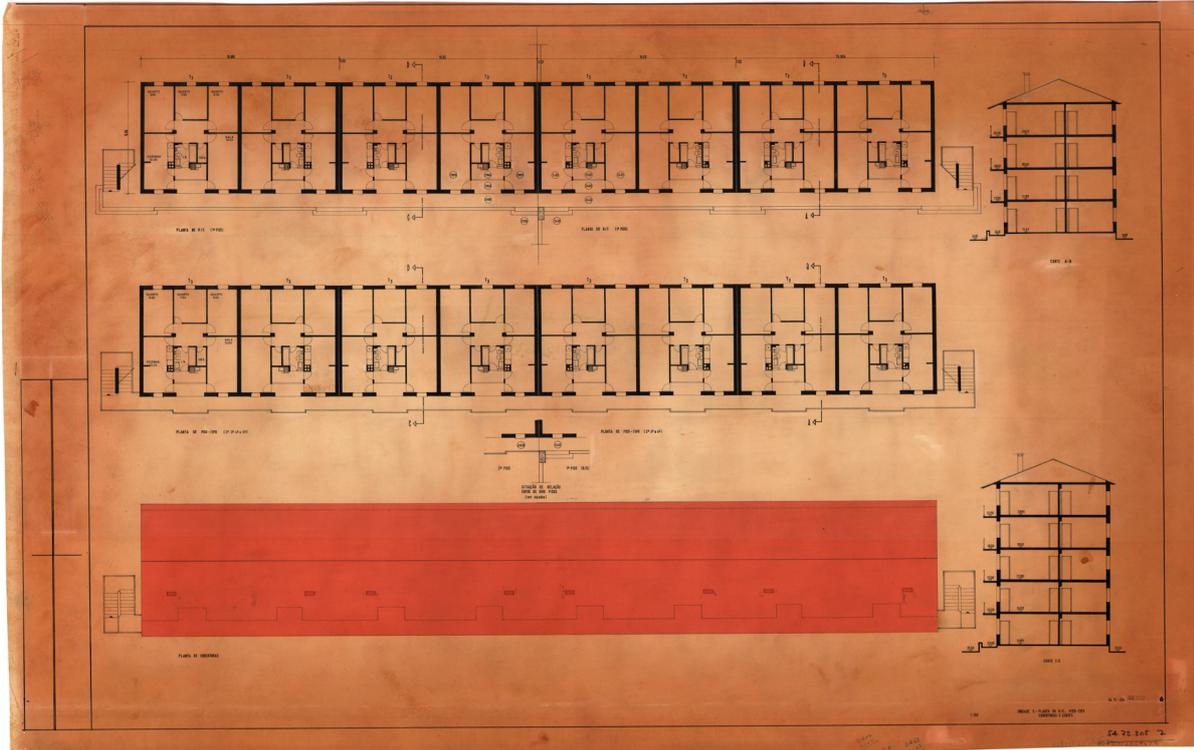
Projeto: unidade C, planta do R/C, piso tipo, cobertura e corte
